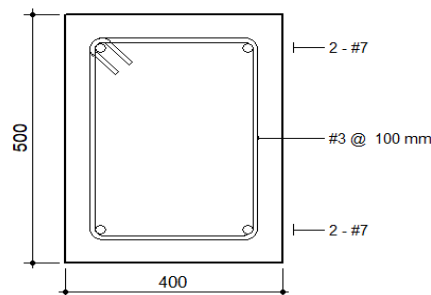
Sección de viga perimetral plantas 5 y 6. Fuente: Propia.
